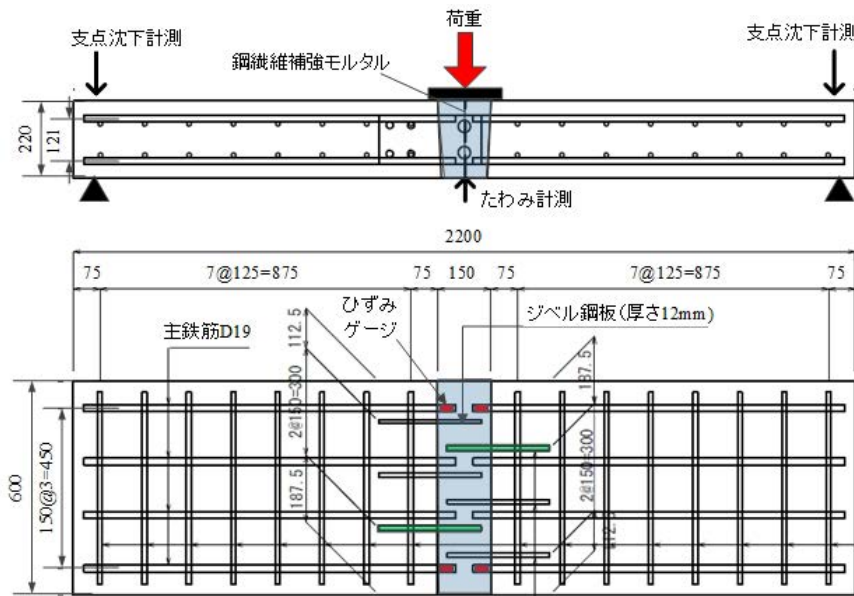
曲げ試験体と試験時の設置状況の一例 (アゴ無しの試験体)(単位 : mm)
